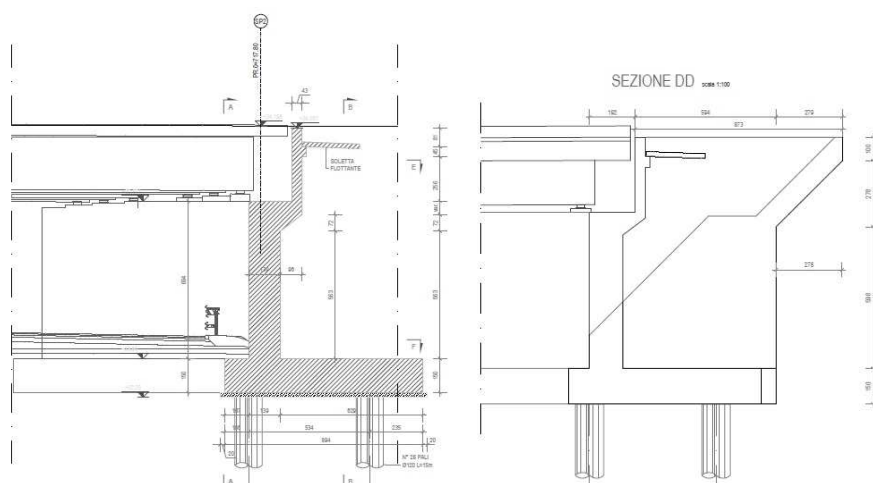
Sezione di carpenteria - Spalla tipo
